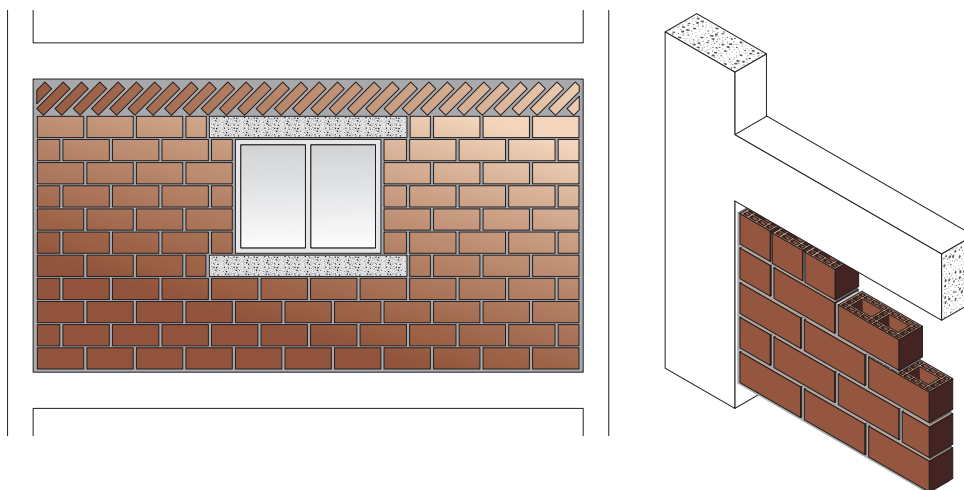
Fixação (“encunhamento”) de parede com o emprego de tijolos de barro cozido ou meio blocos
